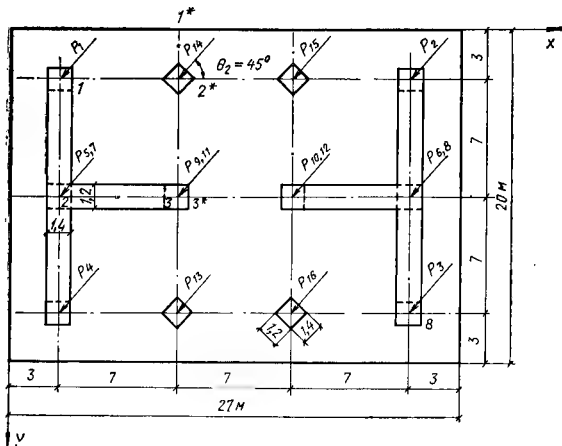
Прямоугольная фундаментная плита под колонны и диафрагмы жесткости
